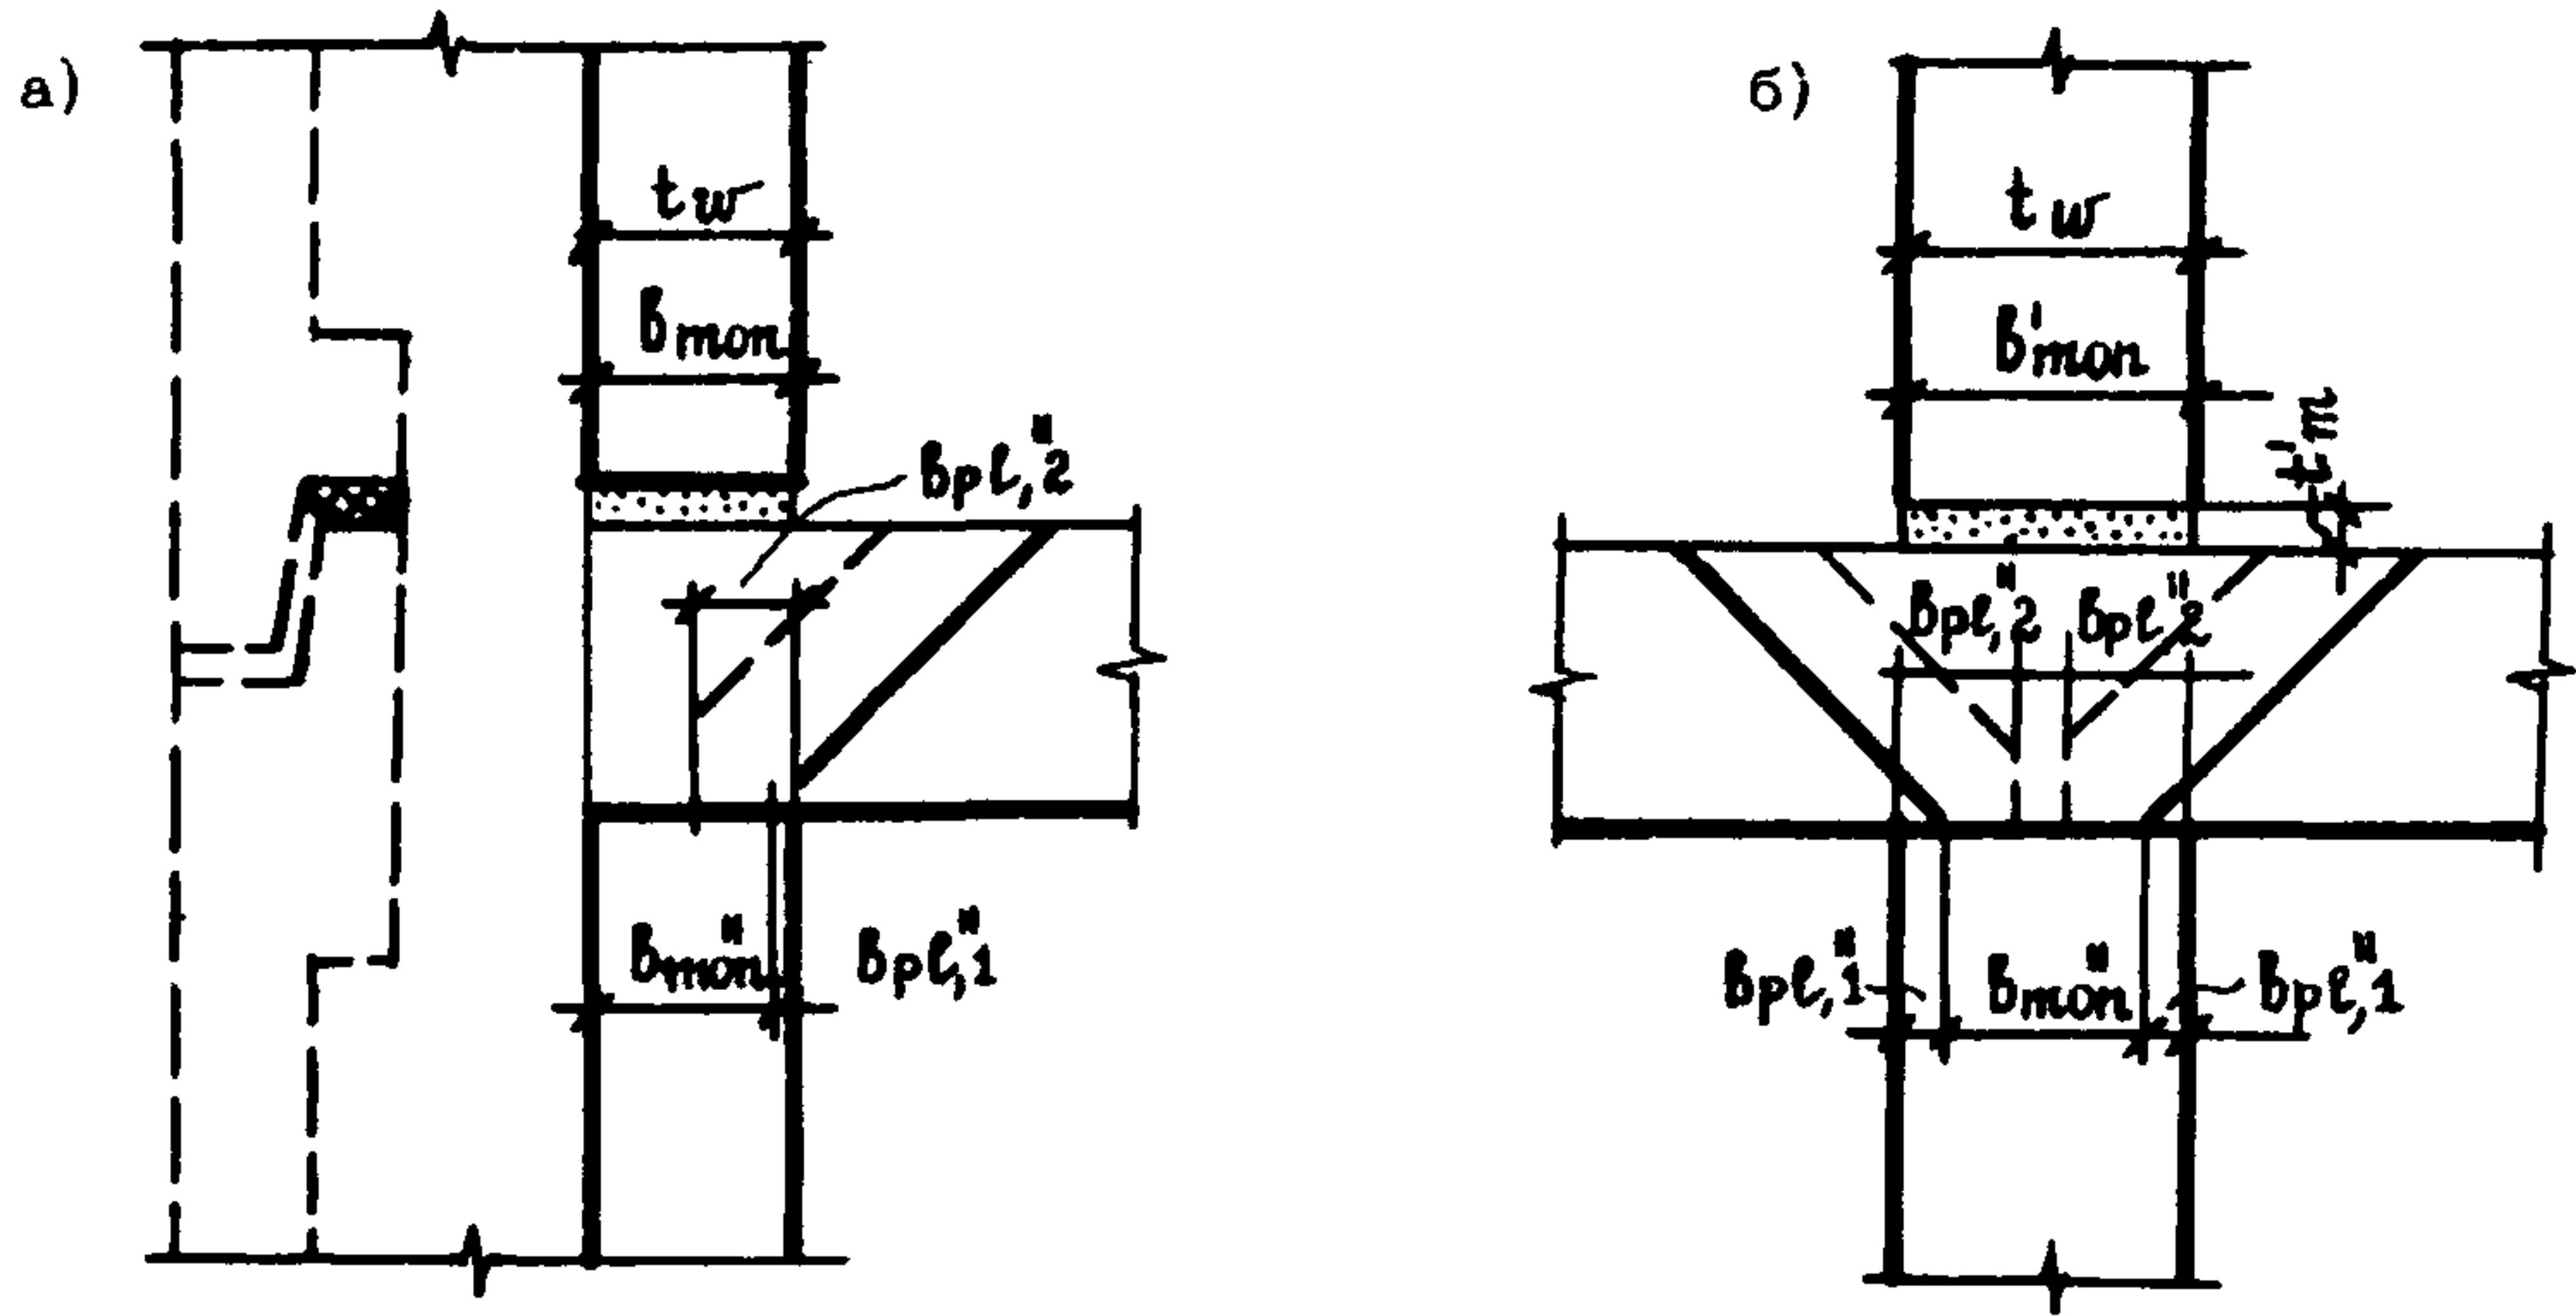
Монолитныестыки с односторонним (а) и двусторонним (б) опирианием плит перекрытий
